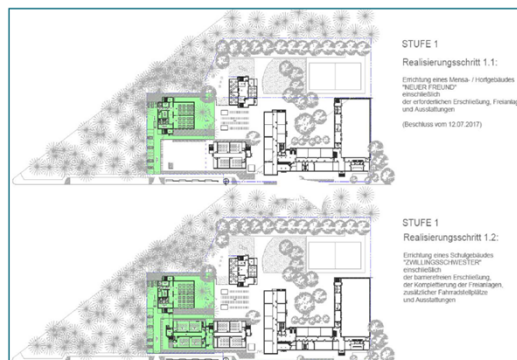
Darstellung zur geplanten Erweiterung des Grundschulstandortes [Quelle: Grundschule am Wald – Konzeption zur Sicherung des Betriebes als verlässliche Halbtagsgrundschule mit Hort – Machbarkeitsstudie - MICHAEL RIEDEL Architekten und Ingenieure, 01.10.2017]
